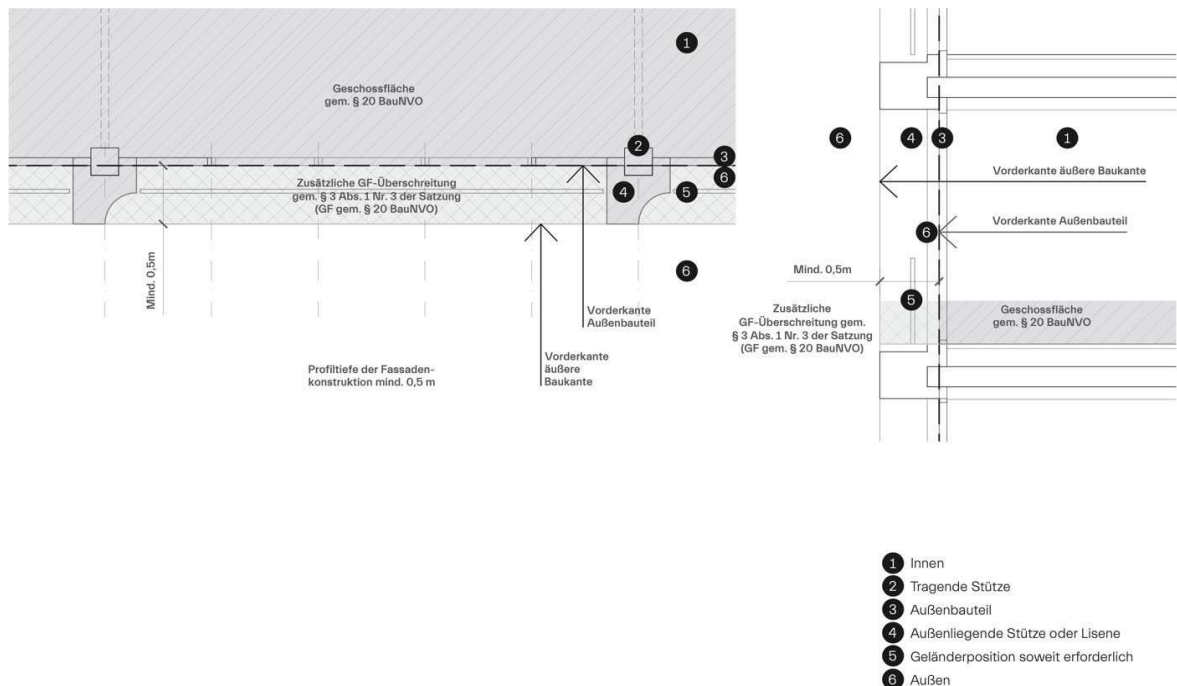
Profiltiefe der Fassaden – Darstellung der Berechnungsgrundlage (ohne Maßstab) ©MOCO+KWR GmbH / Landeshauptstadt München
